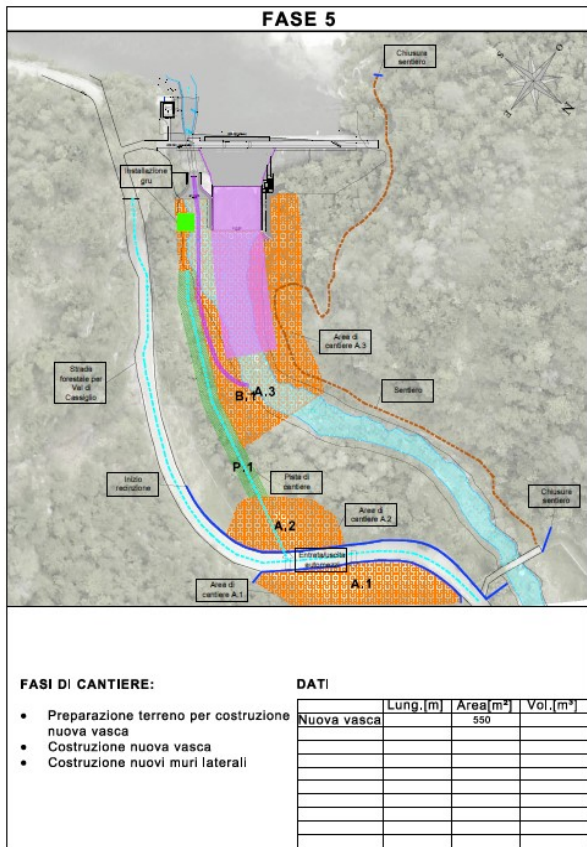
Localizzazione delle aree di cantiere A1 e A2 (estratto foto Studio P&P)
